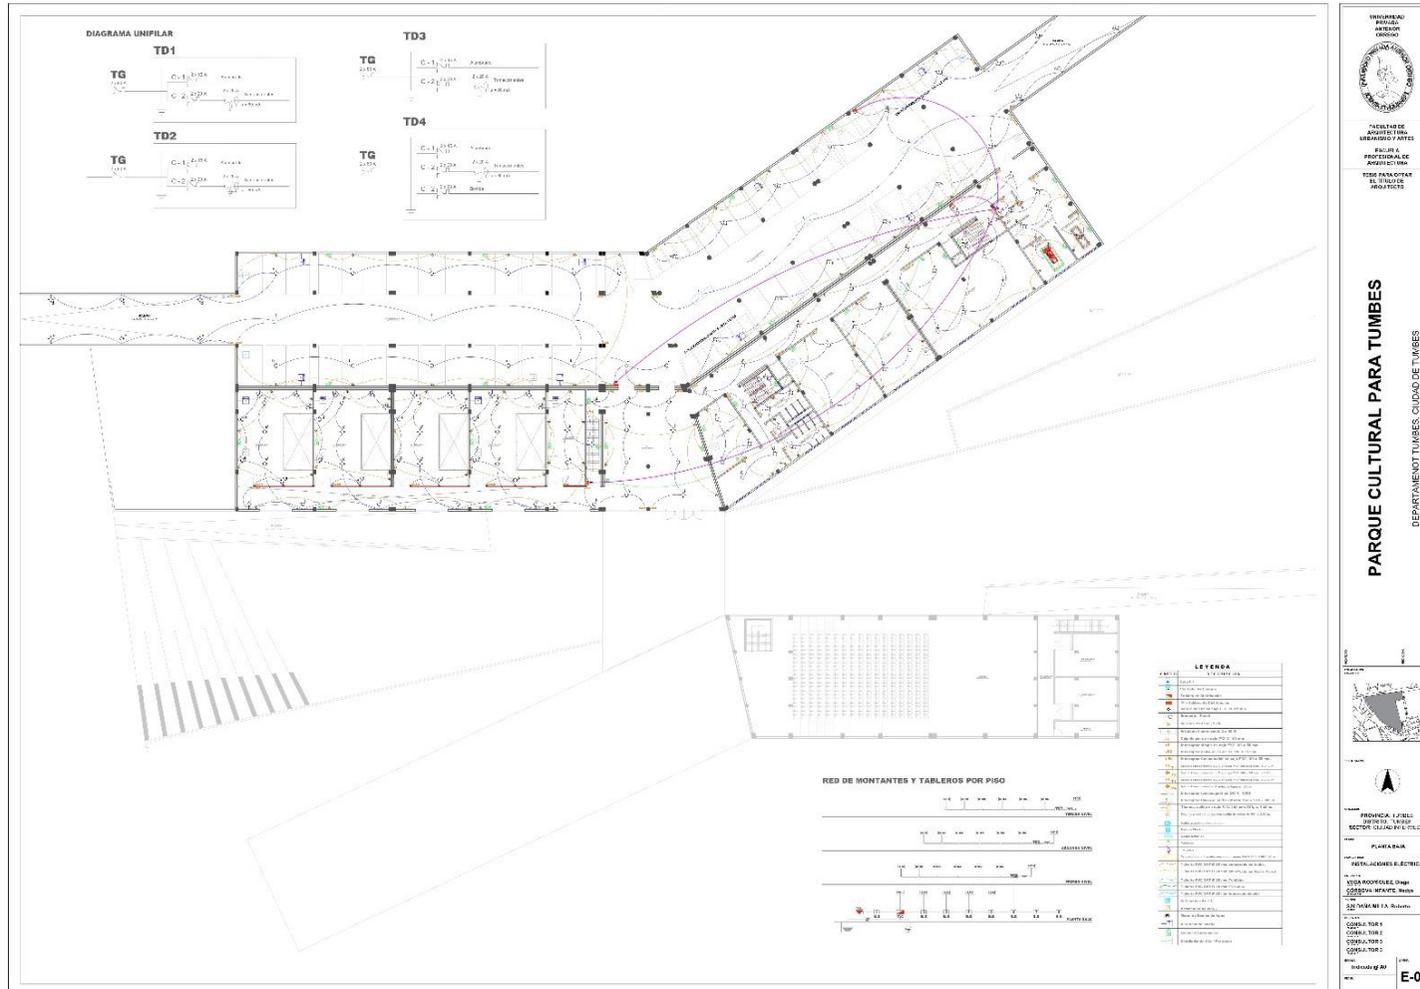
Plano de instalaciones eléctricas – Tercer Nivel
